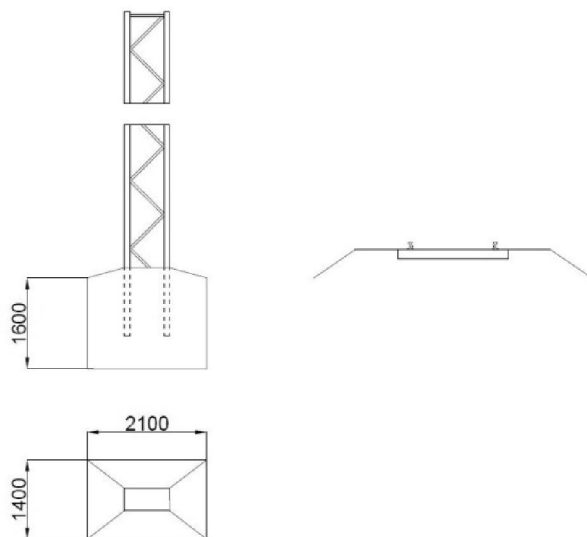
Blocco di fondazione per pali tipo LS (misure in mm)
